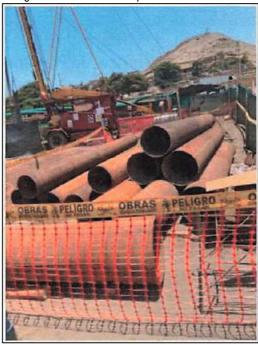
Tuberías en proceso de oxidación que se utilizan para el proceso constructivo. No es la tubería definitiva de la columna de producción."
